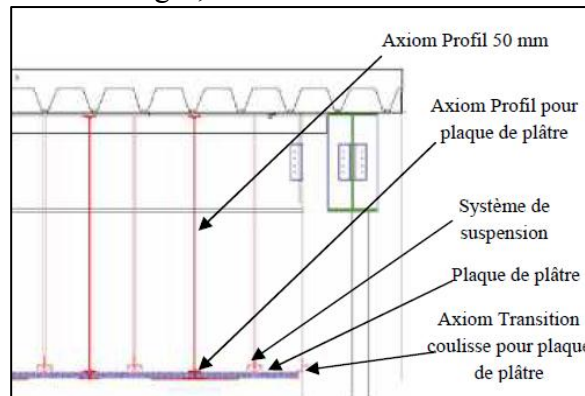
Détail n°7 le faux plafond Source: les auteurs
